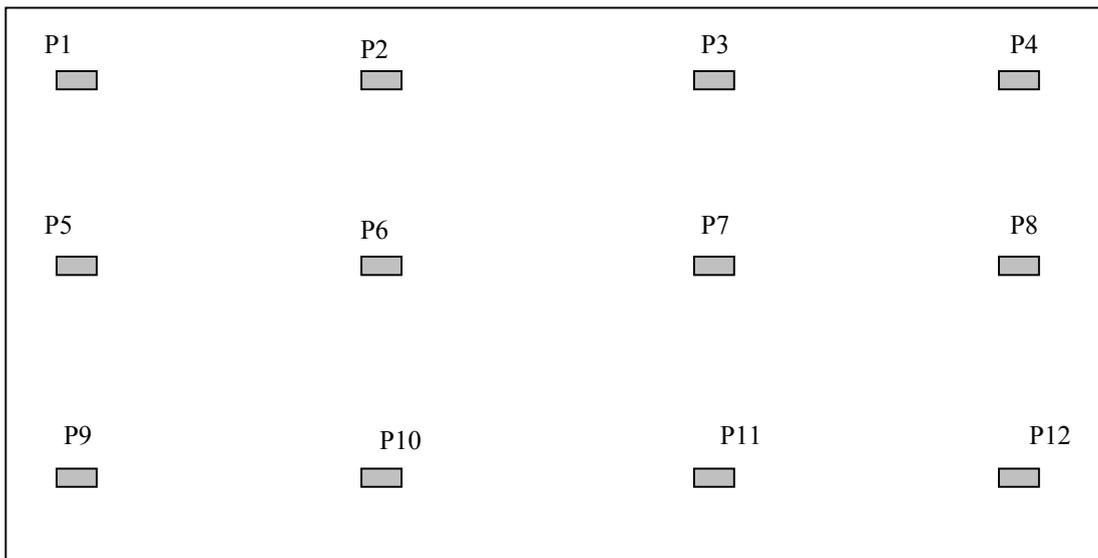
Piso com laje lisa (laje cogumelo) apoiada diretamente em pilares
